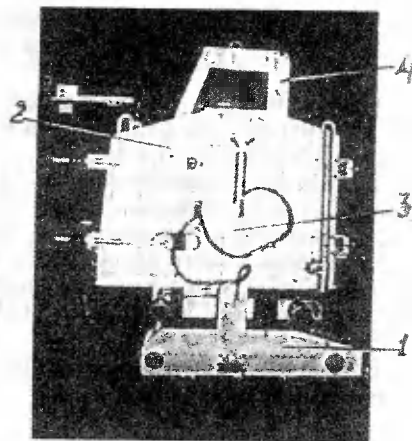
Гидравлическое устройство для демонтажа фундаментов из грунта: 1 — основание; 2 — траверса; 3 — подъемный цилиндр; 4 — направляющий оголовок
